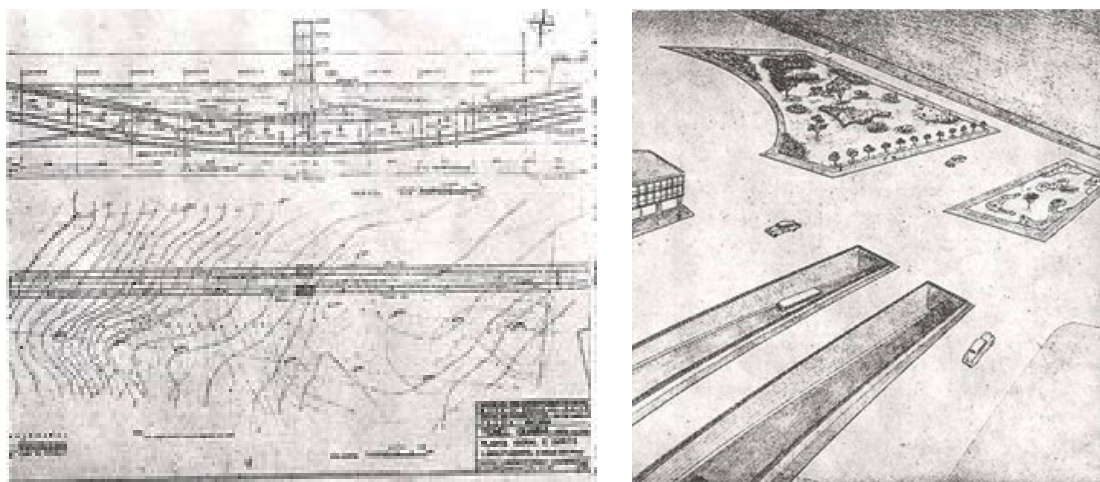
Planta com o corte longitudinal proposto para a construção do Túnel e Croqui perspectivo dos acessos. Identifica-se, ao lado, o desenho do Pórtico do Cais do Porto. Fonte: Revista do Globo, 1950, p.38 e39. Acervo particular do Arq. Nestor Nadruz.
